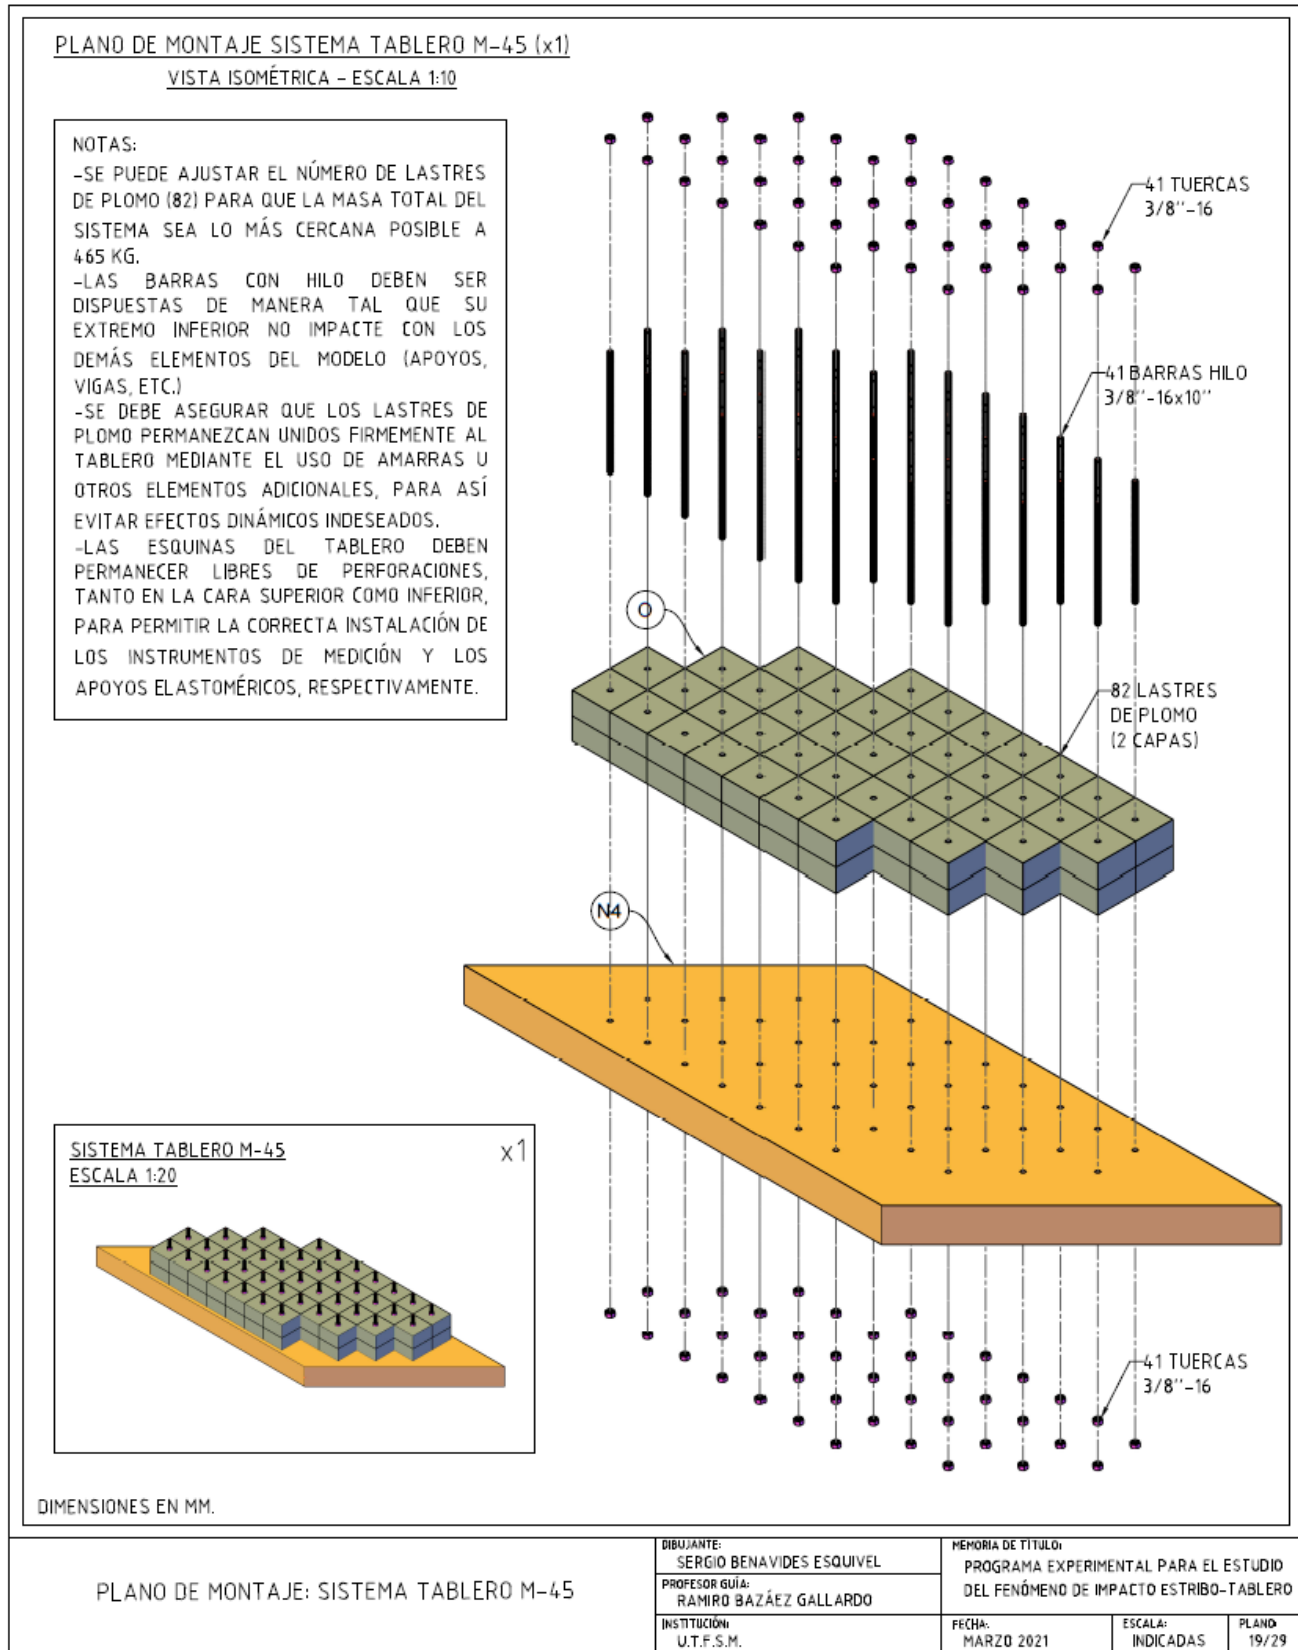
Plano de Montaje: Sistema Tablero M-45.
